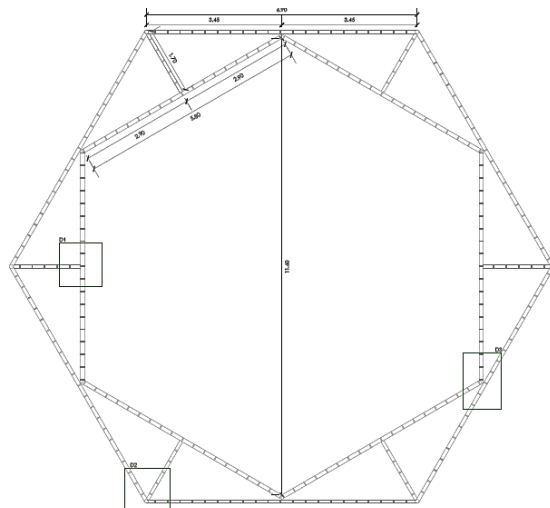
Base estructural de bambú de la cubierta del módulo. Fuente: Elaboración propia.
